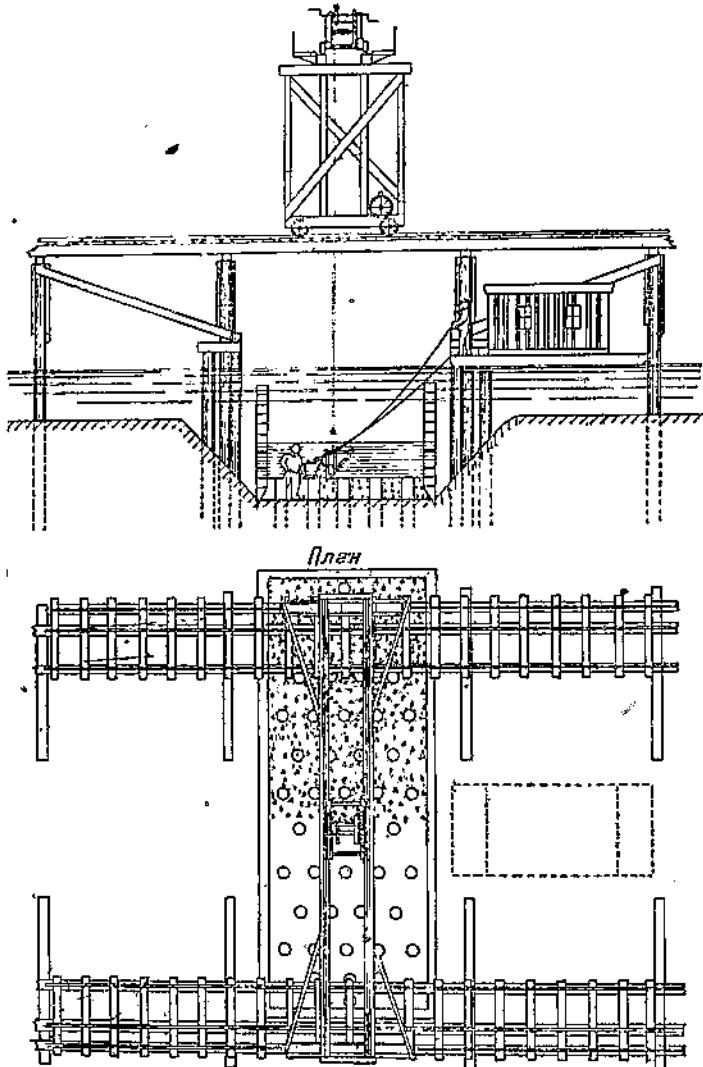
Схема укладки подводного бетона при возведении моста Quincу.
